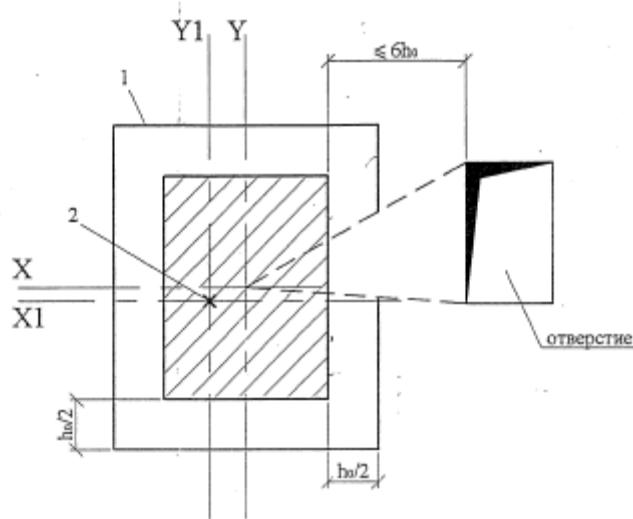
Контур расчетного поперечного сечения плиты с отверстием [5]:
